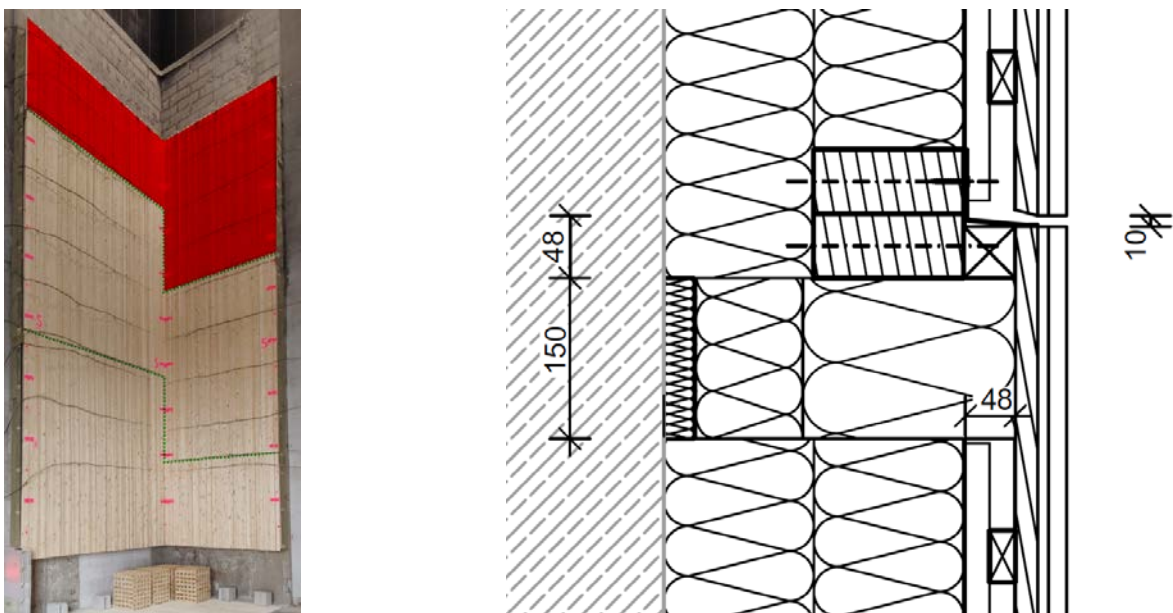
Links: Fassadenprüfkörper der belüfteten Fassade (Lüftungsspaltverschluss grün gestrichelt) mit Brandlast (Holzkrippen) und Darstellung der hinterlüfteten Bereiche (rot); rechts: Vertikalschnitt des Fassadenaufbaus mit Lüftungsspaltverschluss im Geschosswechsel [Angaben in mm]
